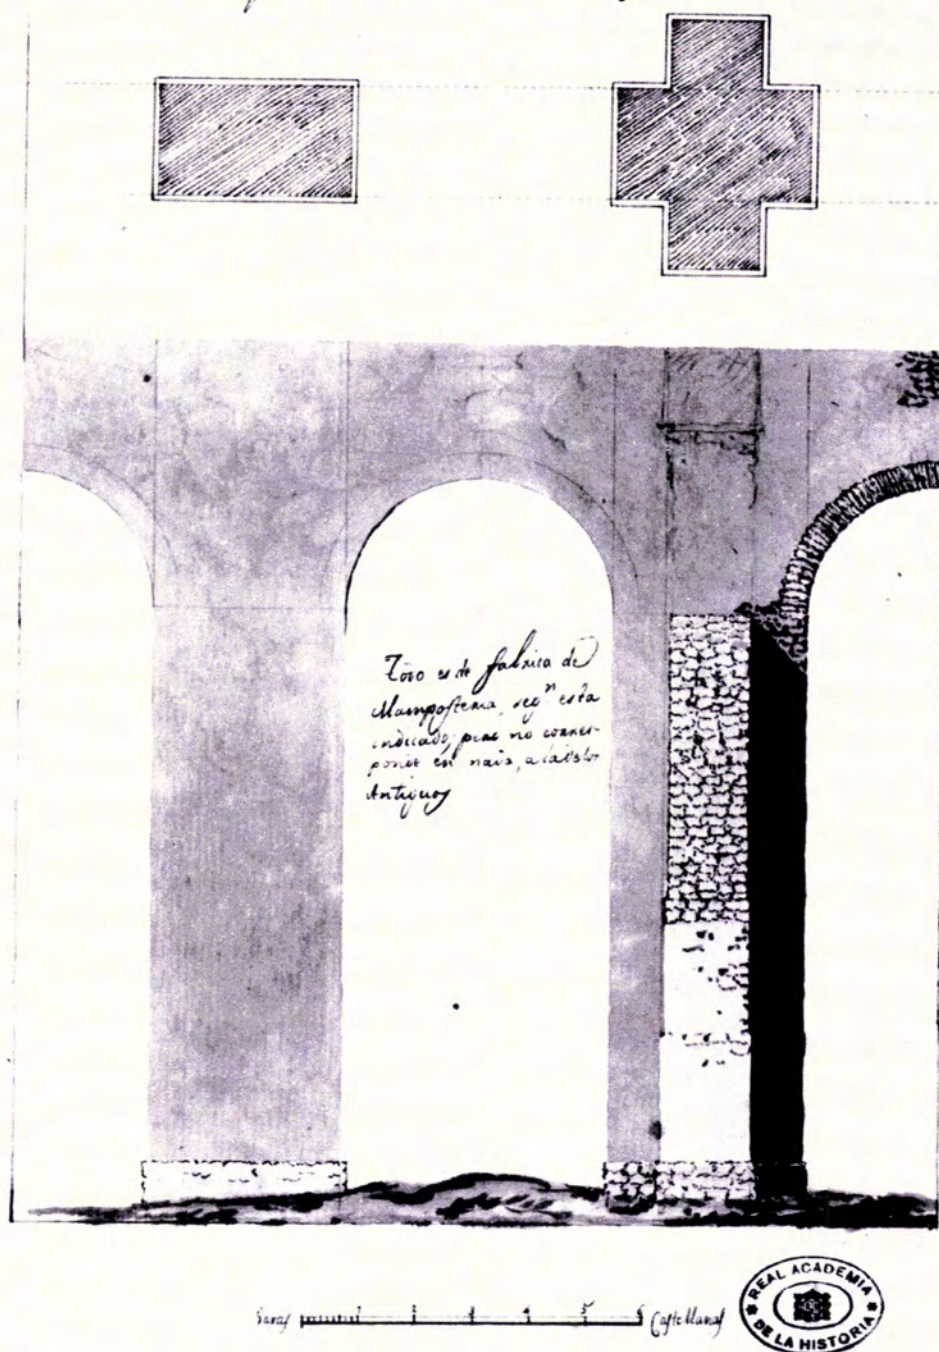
Planta e alçado do Aqueduto. Anónimo, 1798-1801
